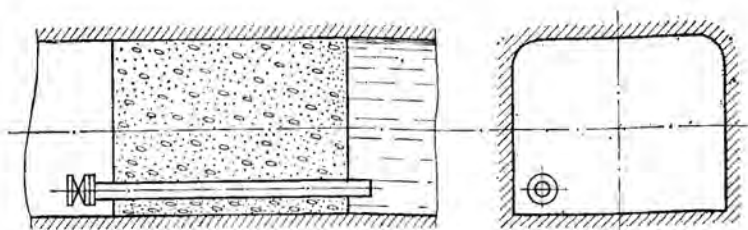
Схема безврубовой прямоугольной водонепроницаемой перегородки
